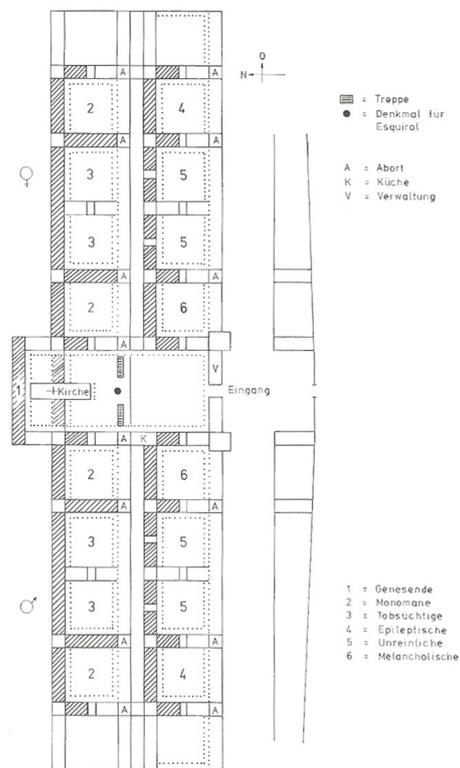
Grundriss La Maison Royale de Charenton
